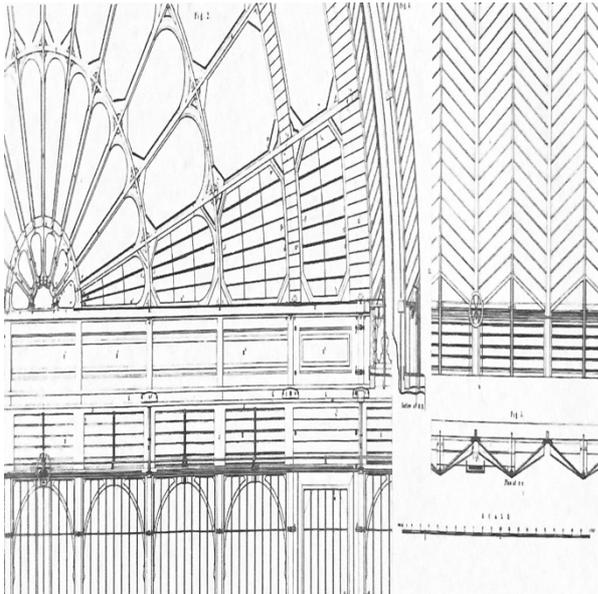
Fassade, Schnitt, Dachaufsicht
